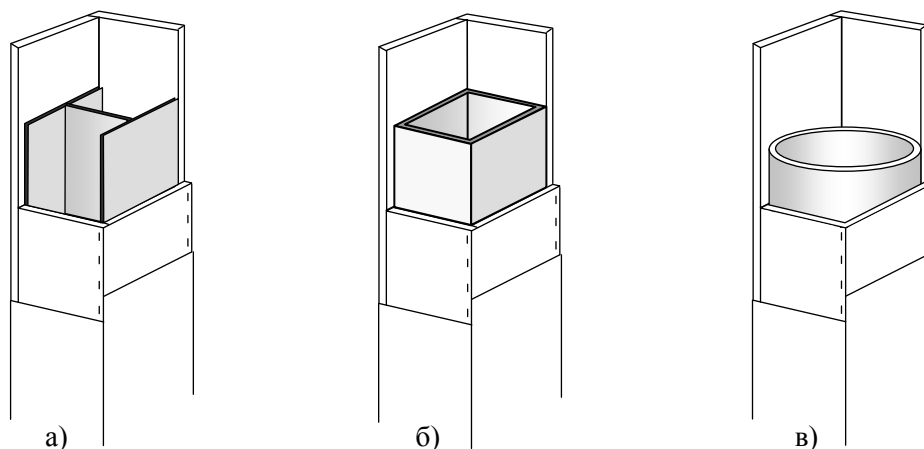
Обшивка несучих конструкцій гіпсокартоном
